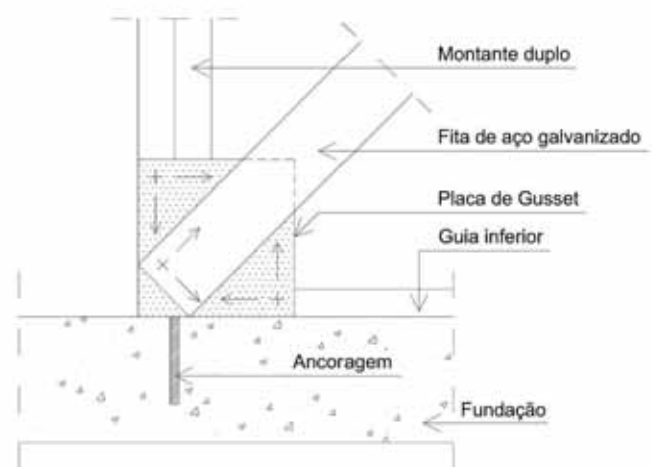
Fixação das diagonais nos painéis por placa de Gusset.
